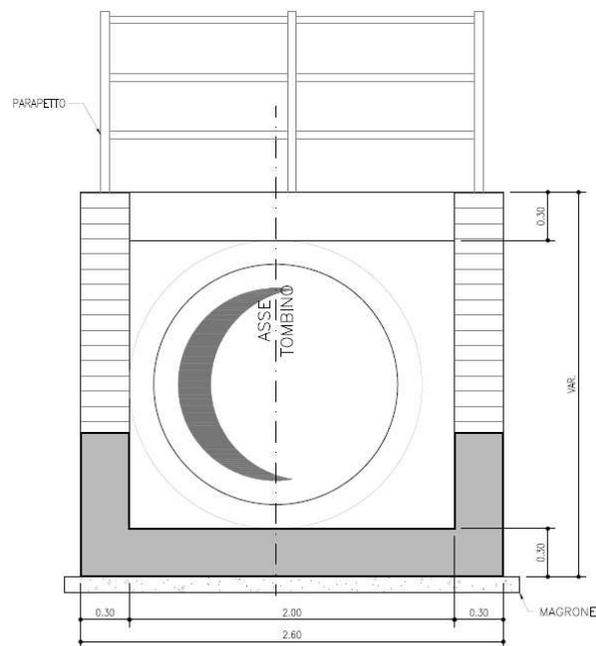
Manufatto di sbocco - Sezione trasversale
